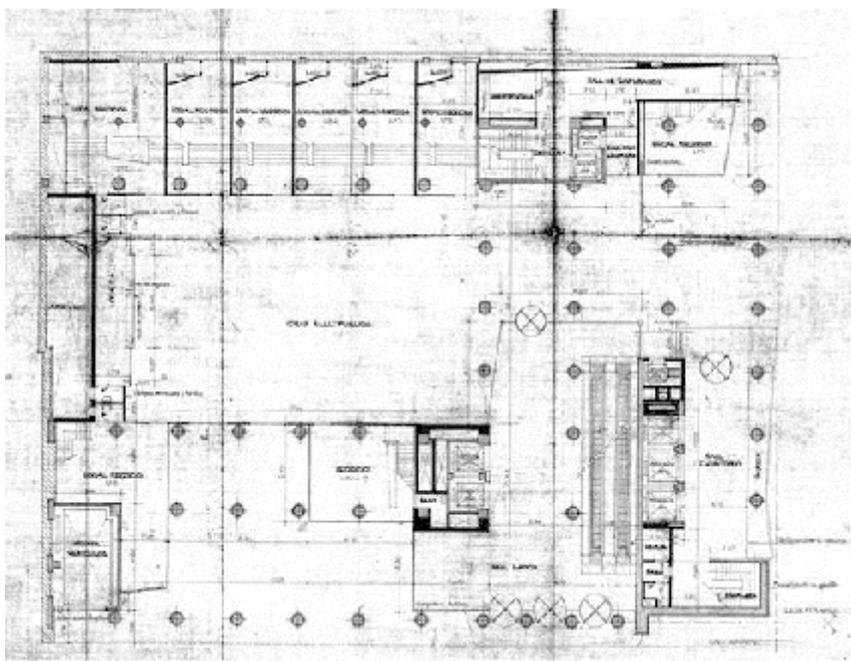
Planimetría de la planta baja de la sede local del Banco Provincia de Buenos Aires – en San Martín y Córdoba-, con la distribución original de su galería comercial. Fuente: Archivo y Museo Históricas del Banco de la Provincia de Buenos Aires “Dr. Arturo Jauretche”
